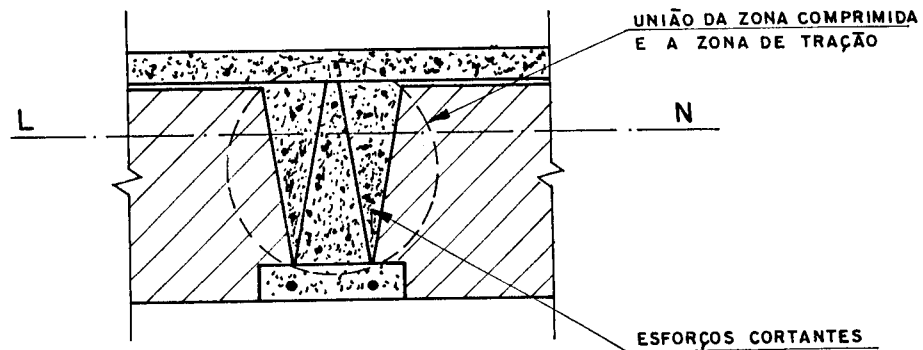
DETALHE DO SISTEMA ACABADO
